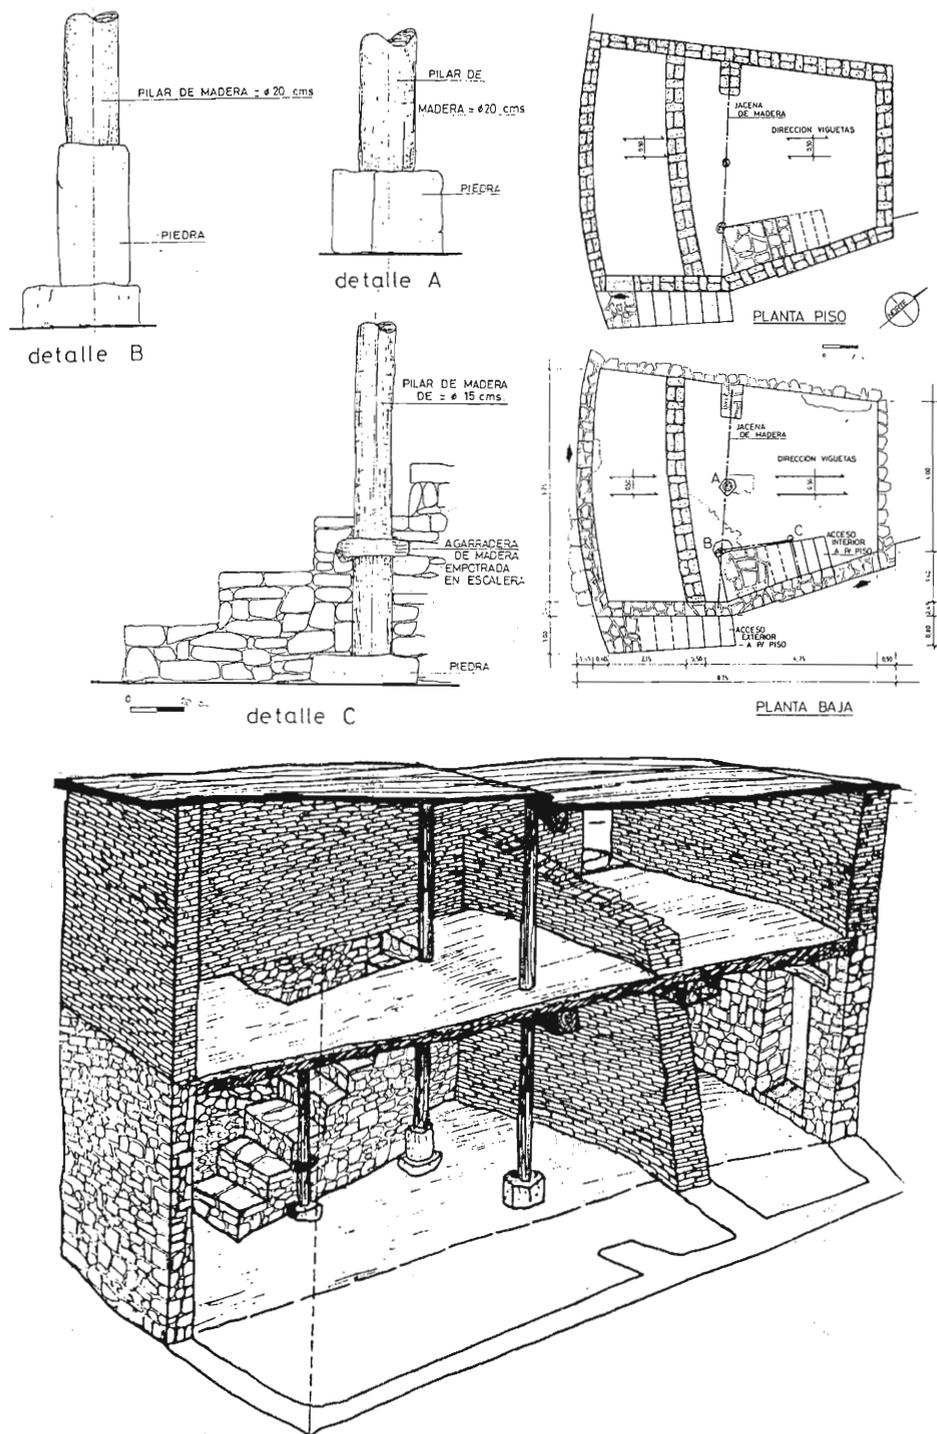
Reconstrucción hipotética de la vivienda pluricelular vertical, recinto 2 y 3, alzado, planta inferior y superior, y detalles (J. Plá Ros).
